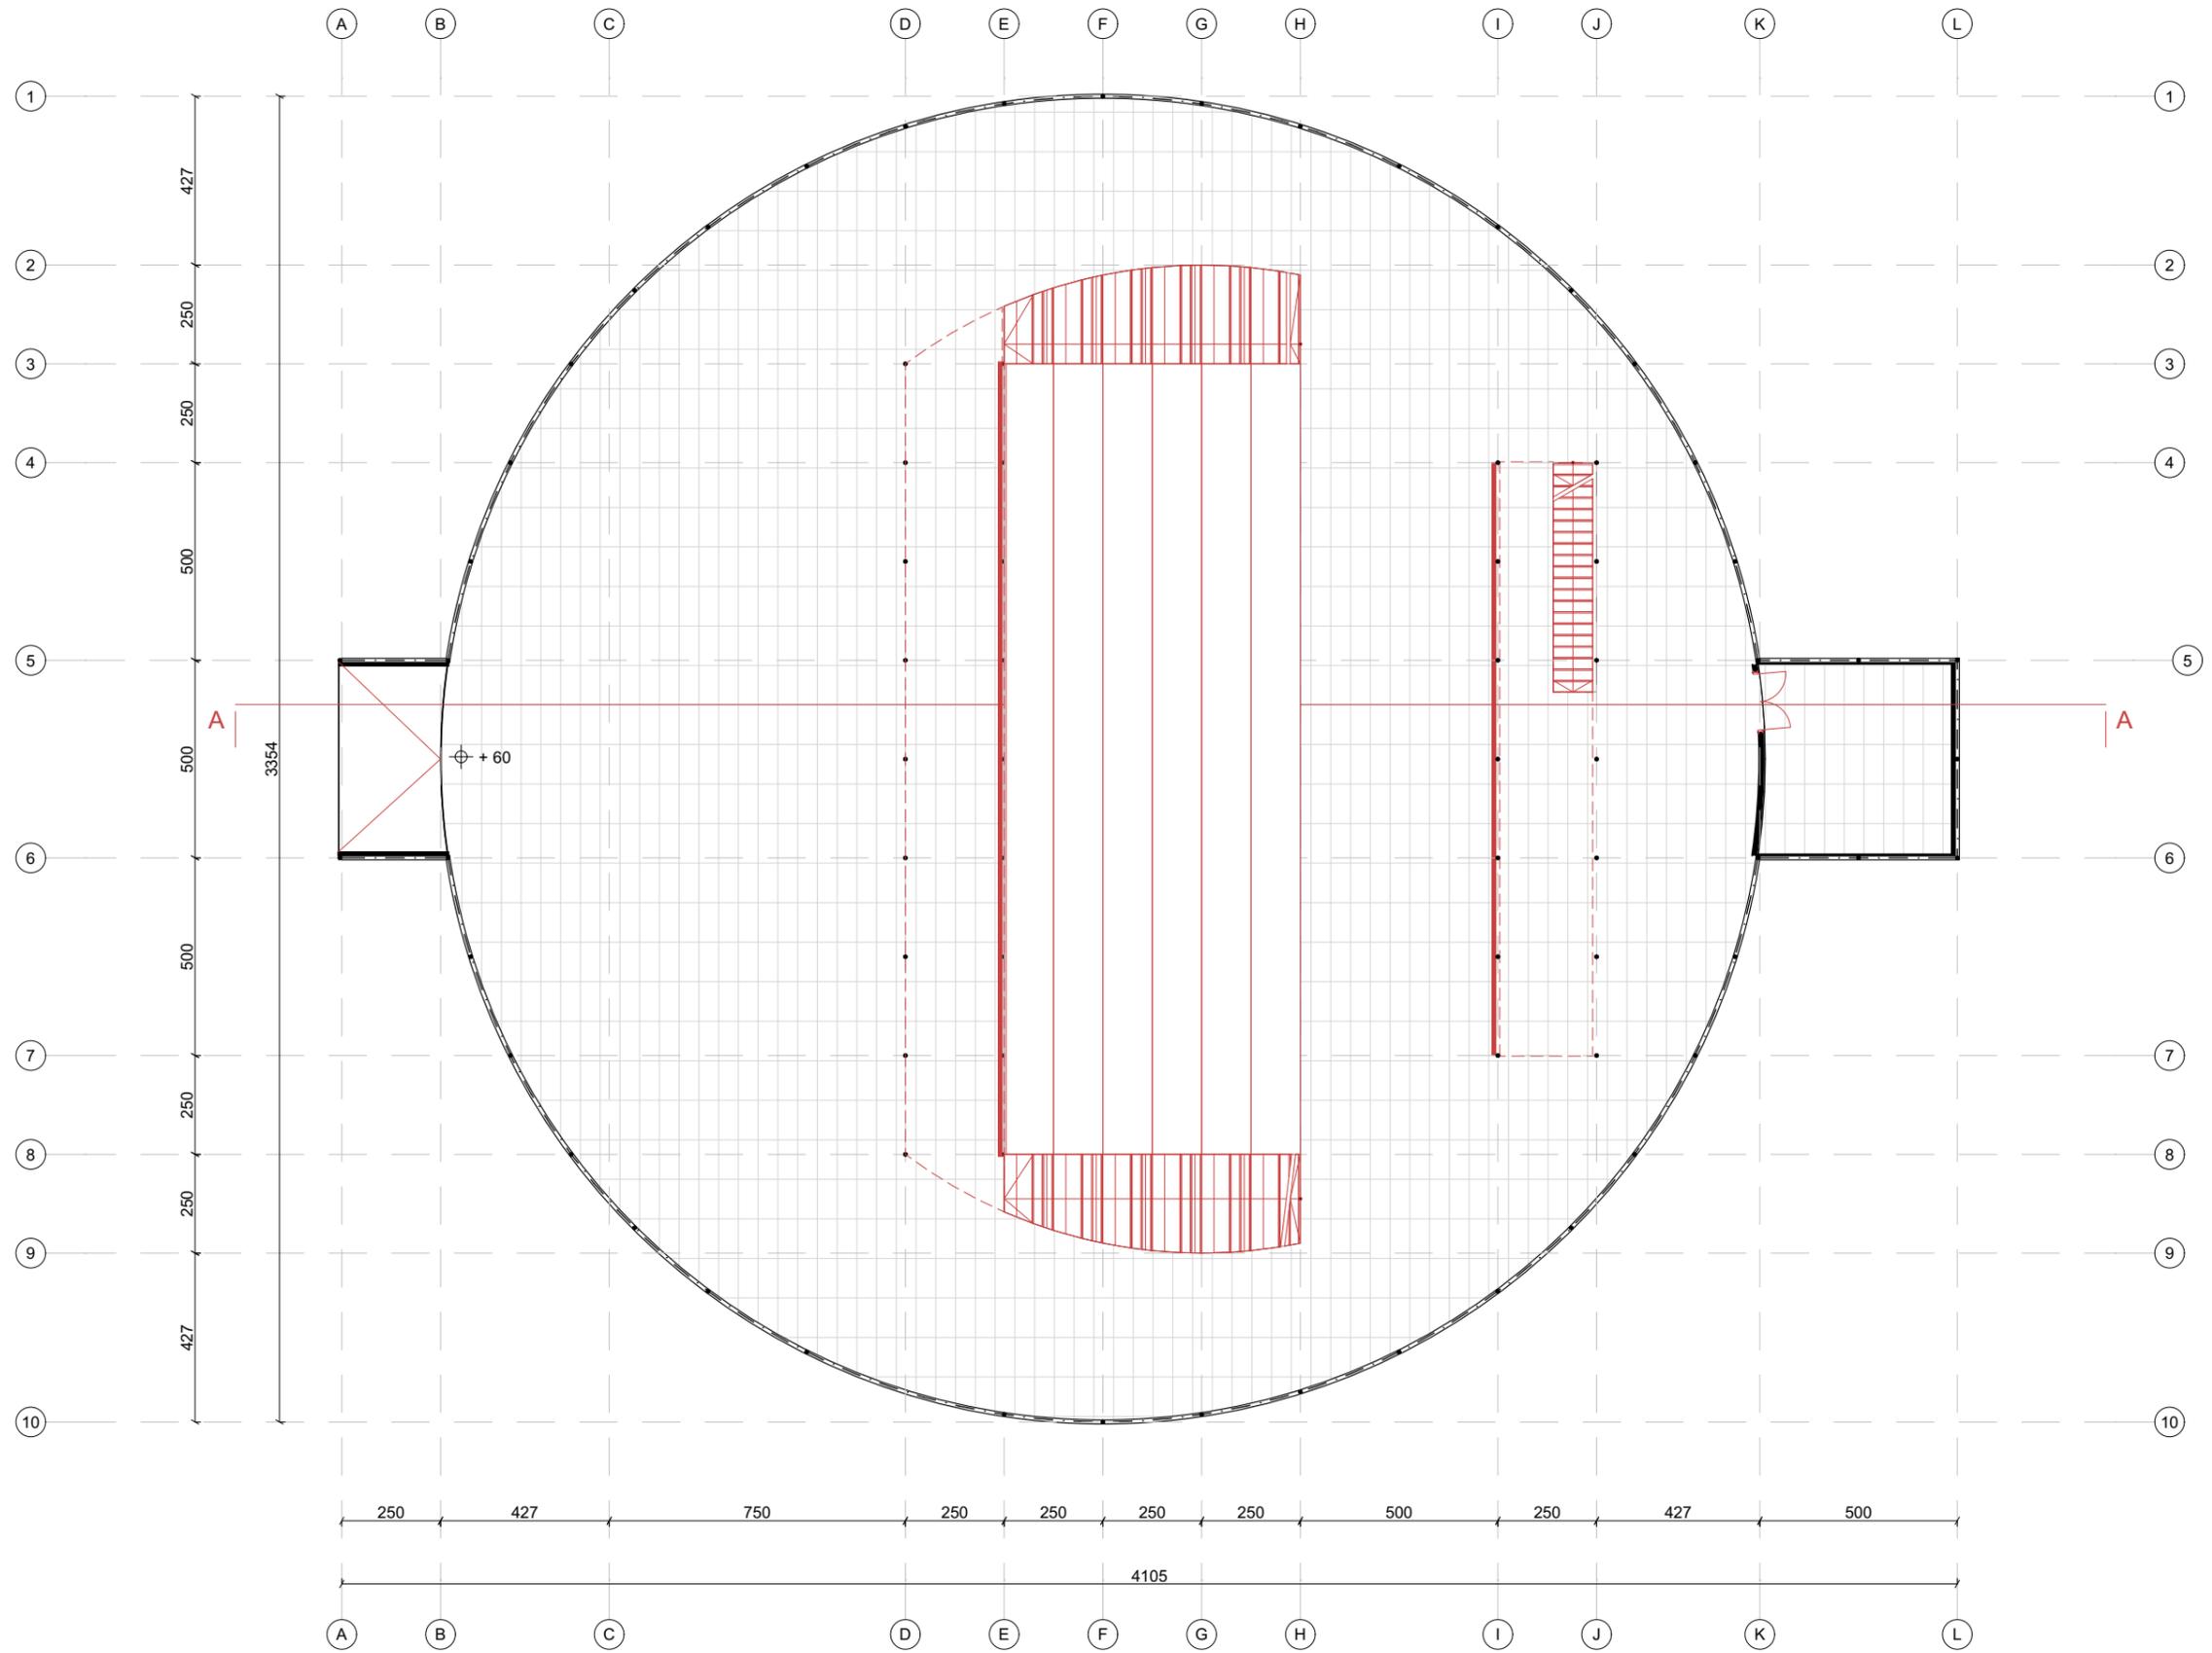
Planta (Fuente: Elaboración Propia. 2023)
